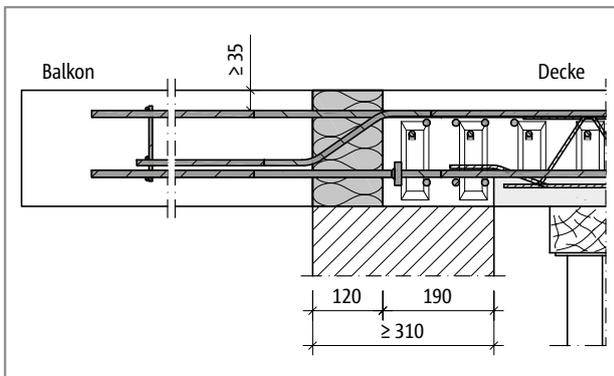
Schöck Isokorb® Typ EXT: Elementplatte mit Randunterstützung mit wärmedämmendem Mauerwerk (Schnitt EXT-L-CV35, Ansicht EXT-R-CV50)
